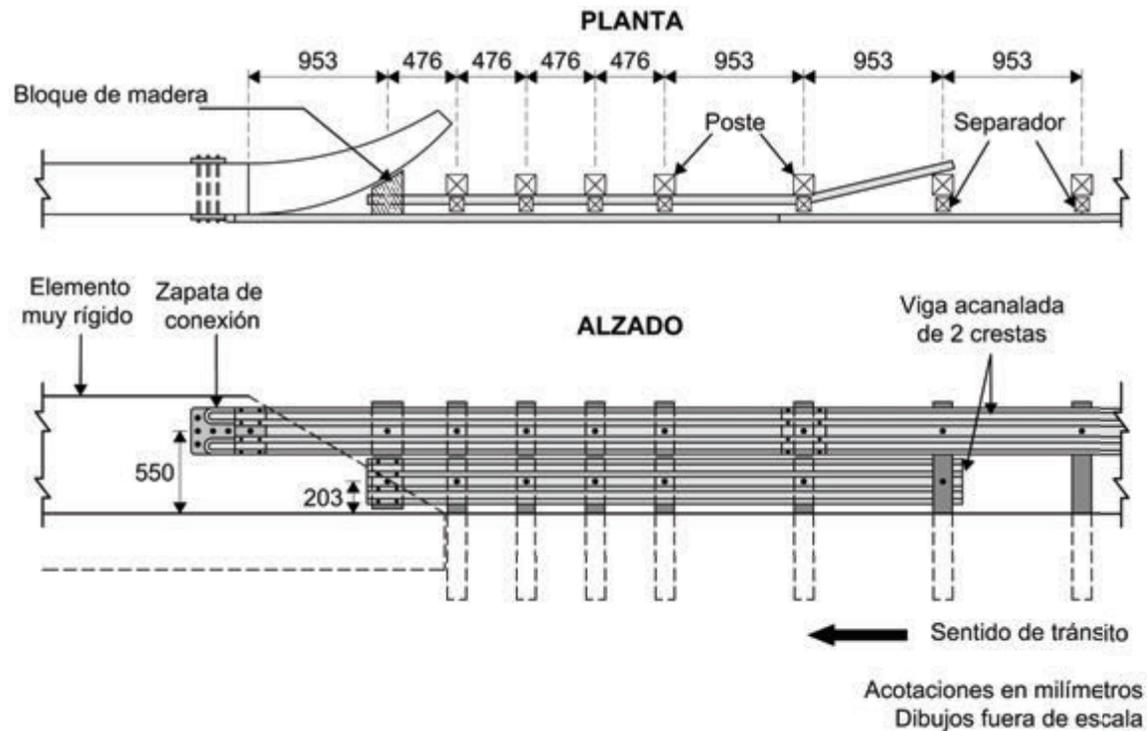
Transición de barrera metálica de doble bandas a muro curvo
